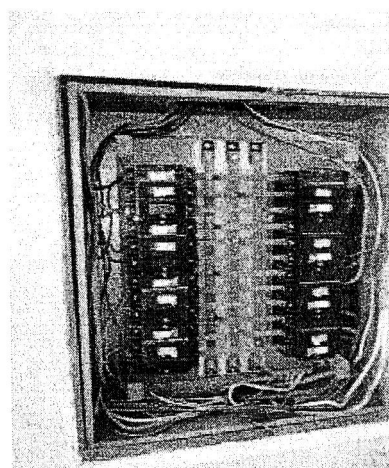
tablero eléctrico en mal estado debido a la antigüedad
